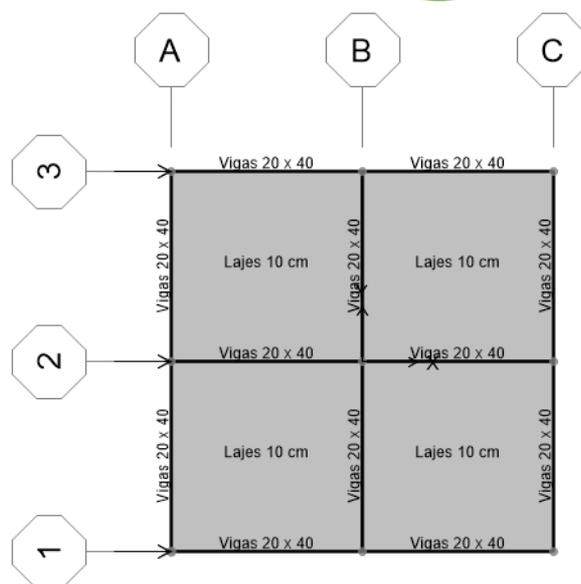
Nomenclatura dos pórticos, dimensões de vigas e lajes e direção de aplicação das forças para geometria quadrangular.
